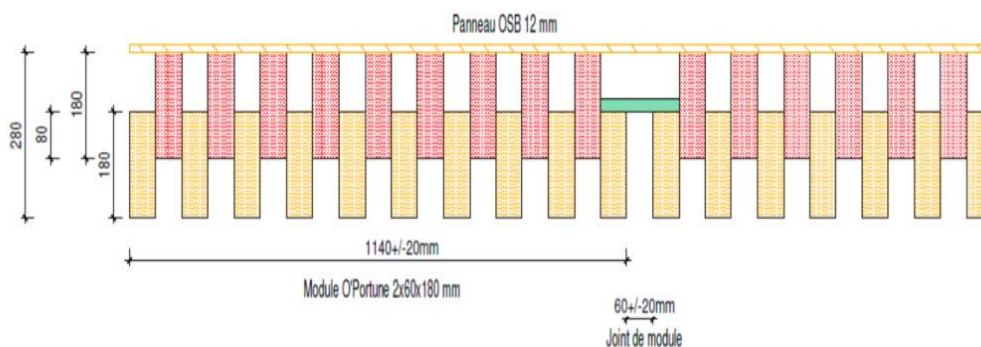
Coupe de la dalle O'portune pour comprendre le système constructif [33]
